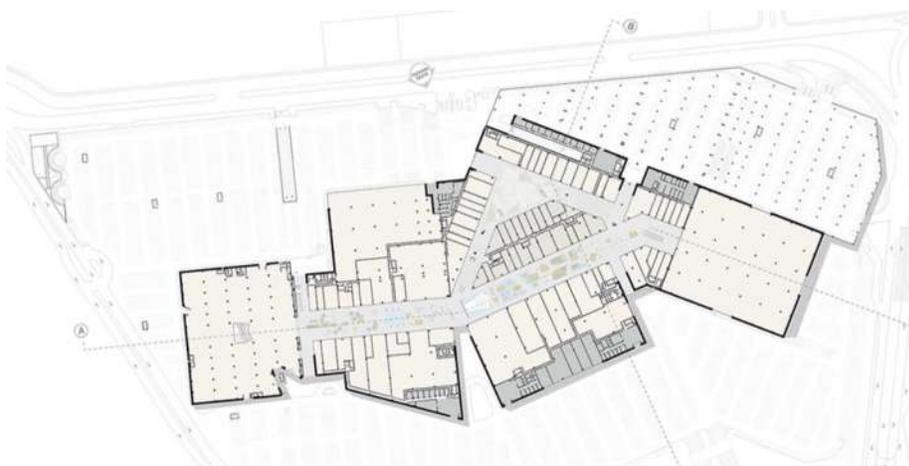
Plano arquitectónico, primer planta. Fuente: <http://antea.mx/> Autor: RISG
